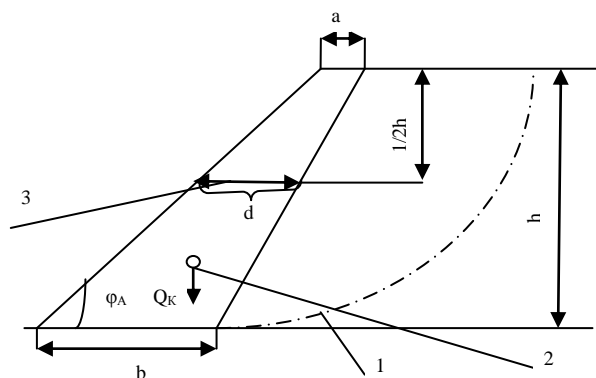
Поперечное сечение уступа, укрепленного контрфорсом: 1 - линия скольжения в уступе; 2 - центр тяжести контрфорса; 3 - средняя ширина контрфорса
